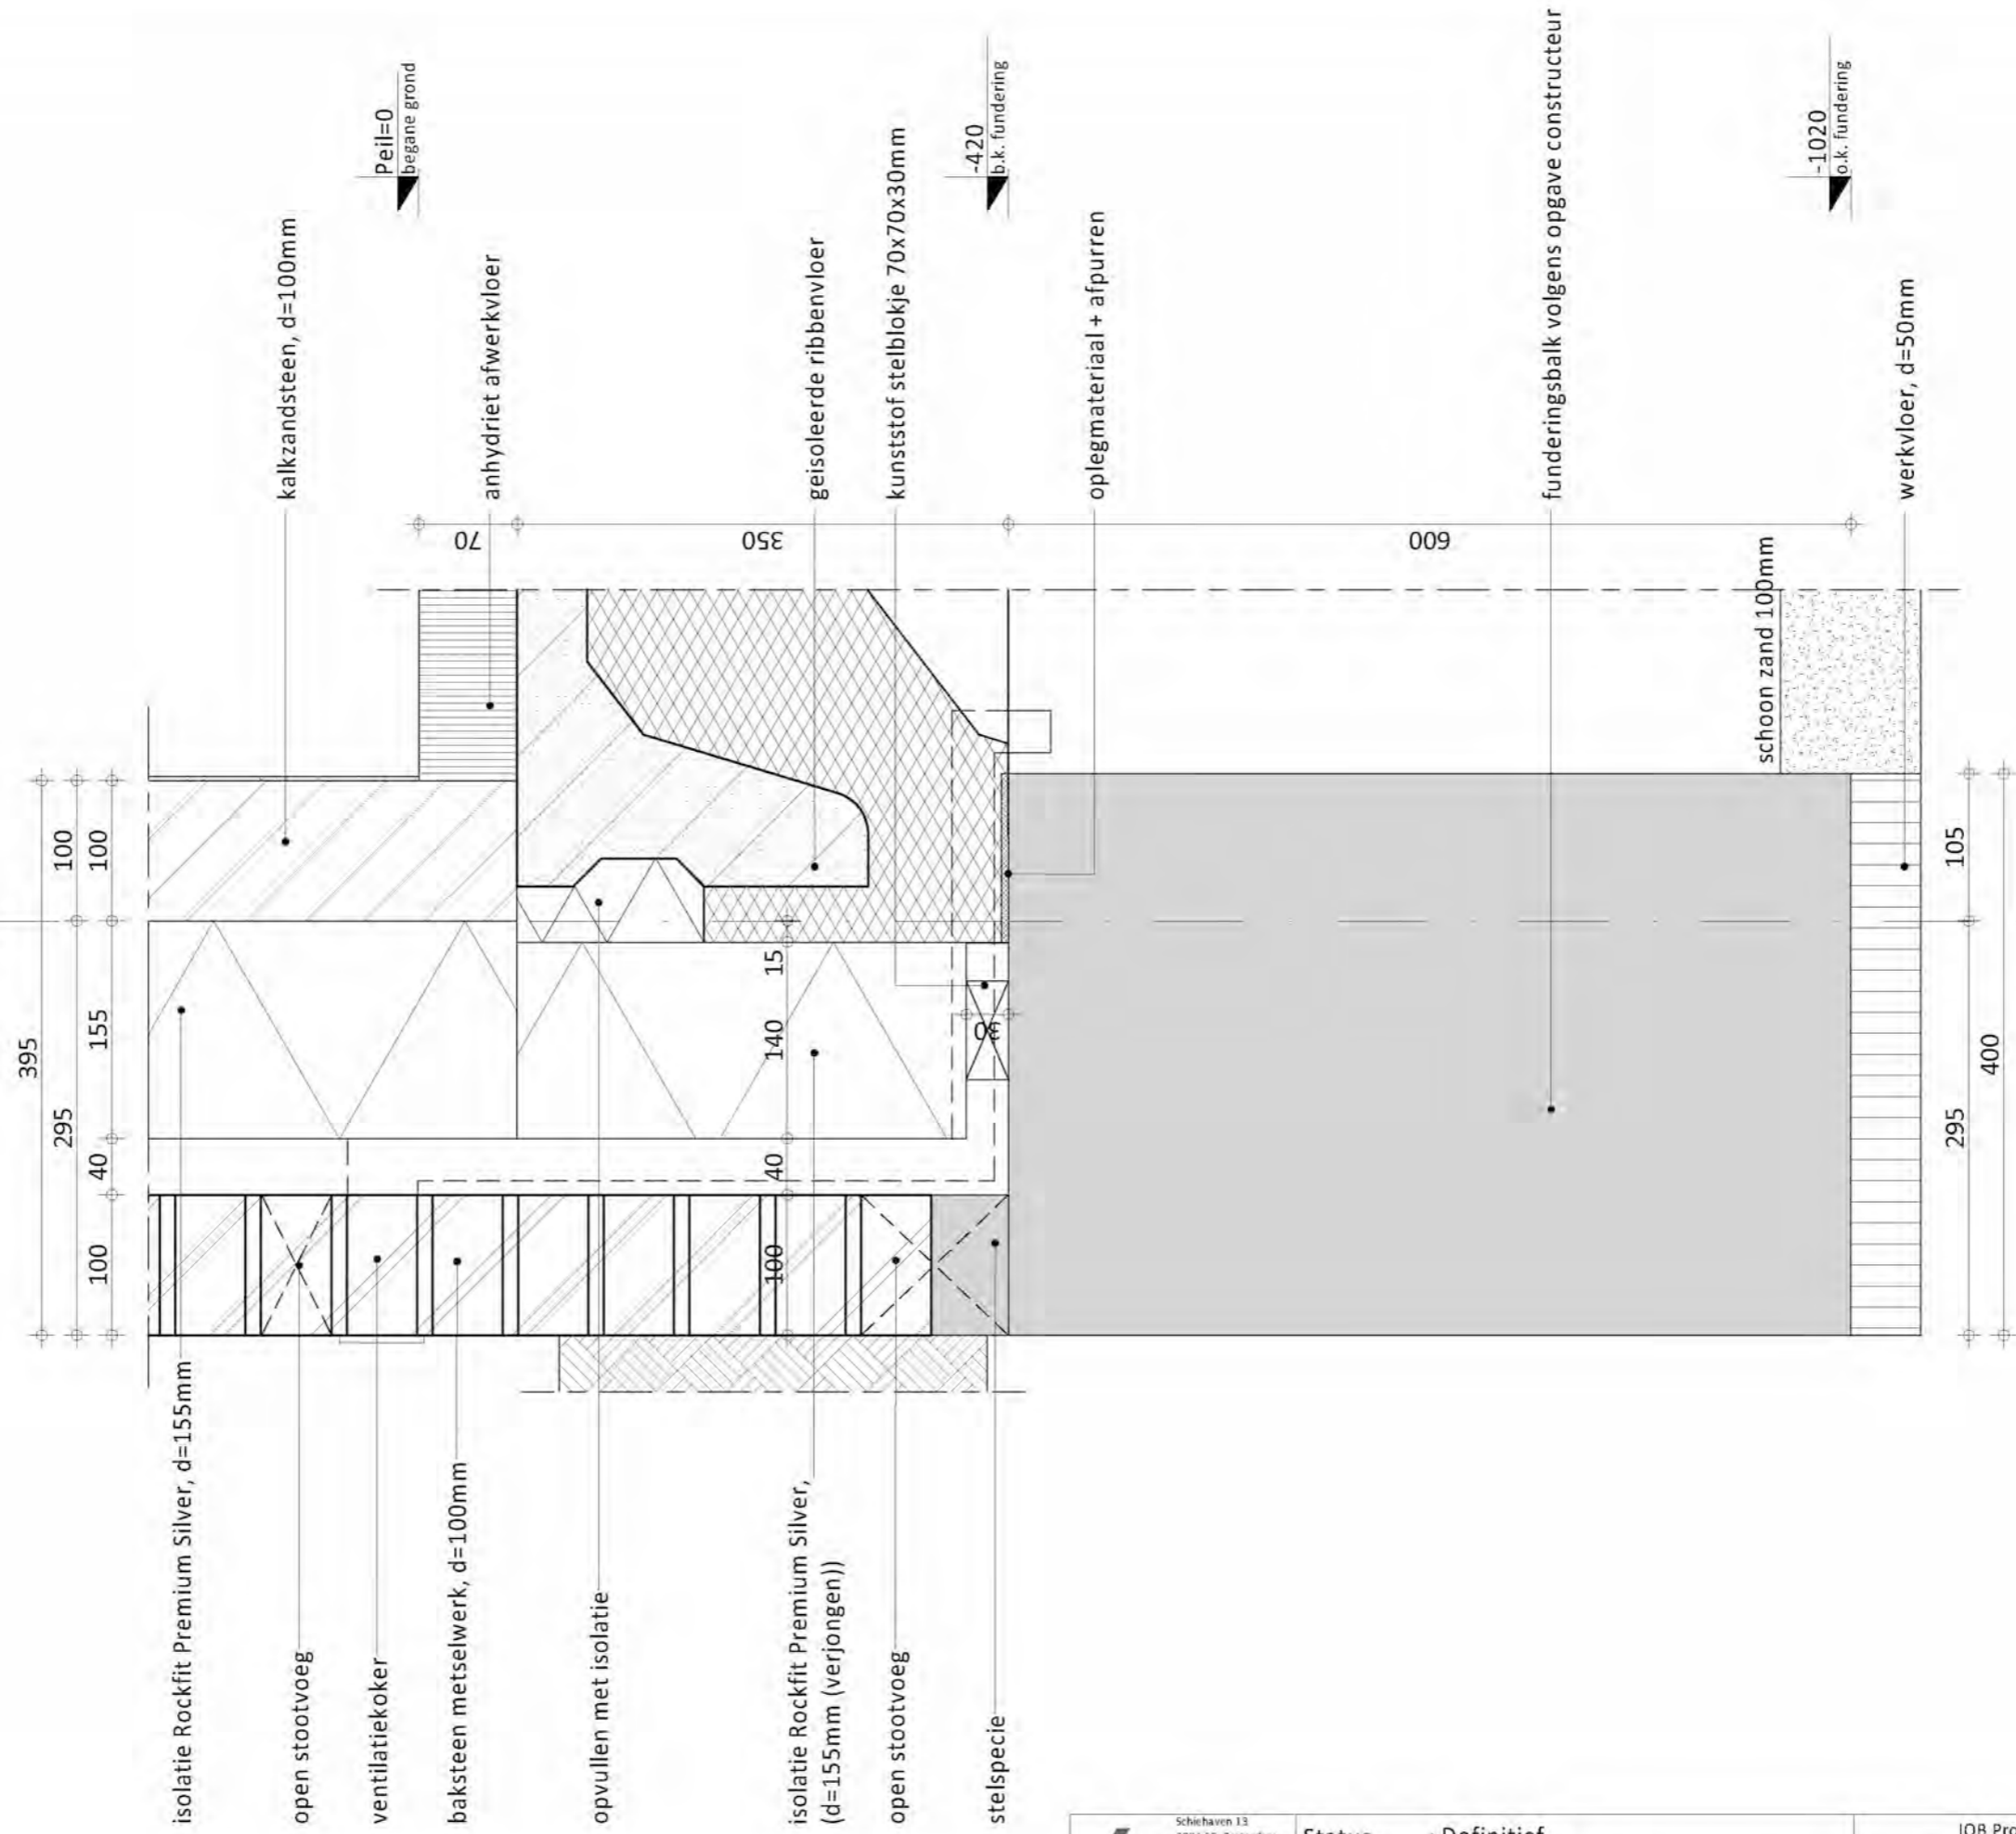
DETAIL T.P.V. VERDIEPINGSHOGE PUI
